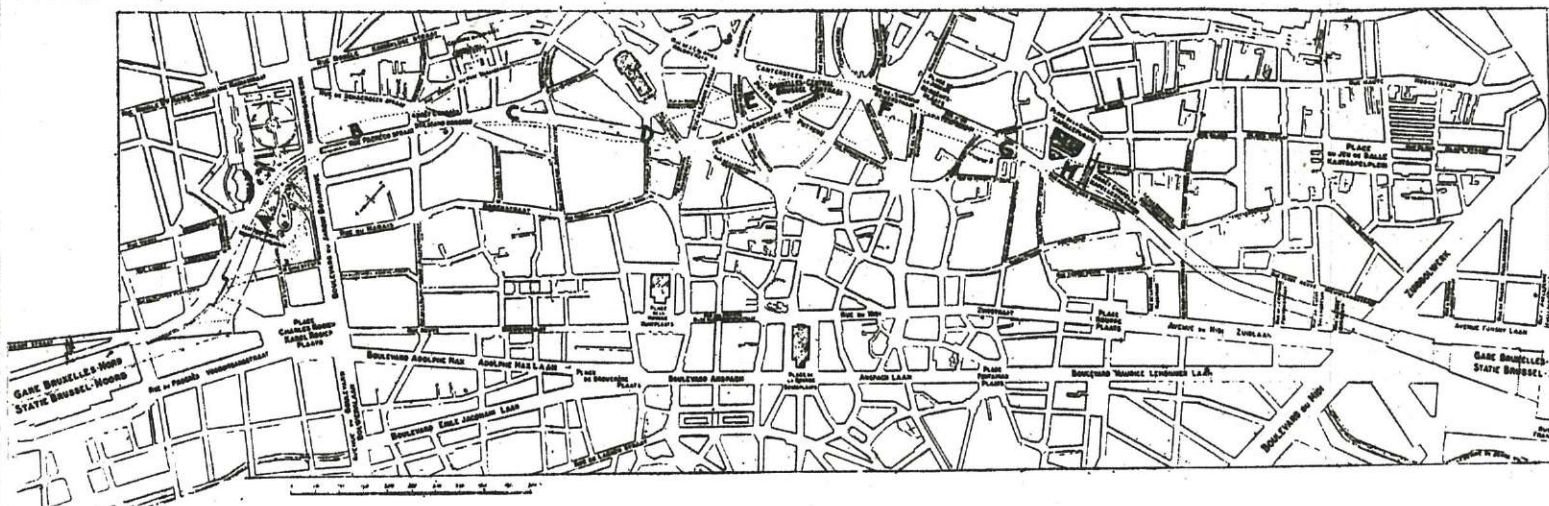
Tracé en plan du tunnel à six voies de la Jonction Nord-Midi.
